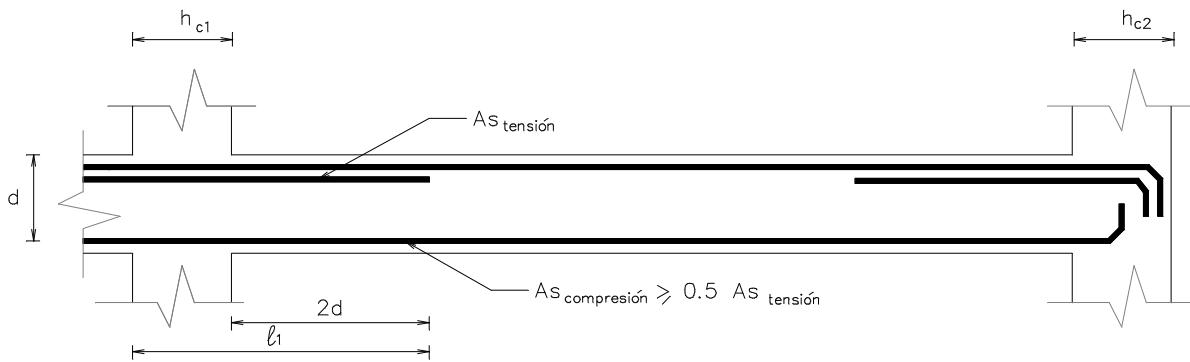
Requisitos del acero de refuerzo longitudinal en vigas de marcos dúctiles
